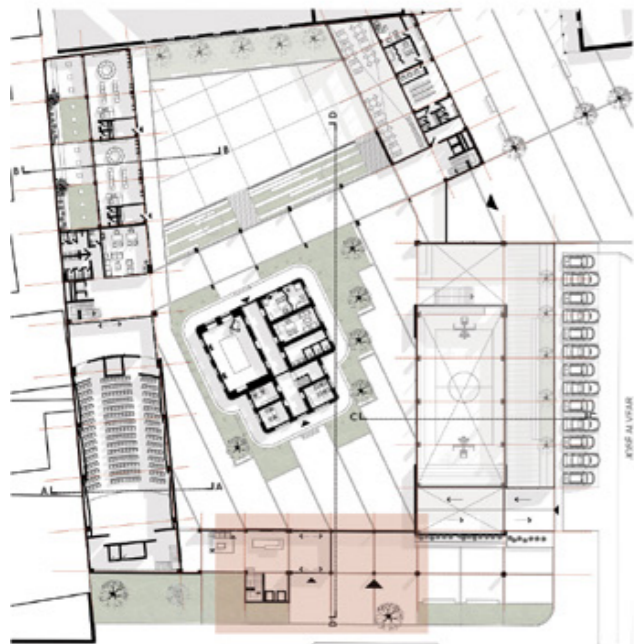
Esquema Planta baja | Fuente: Elaboración propia
